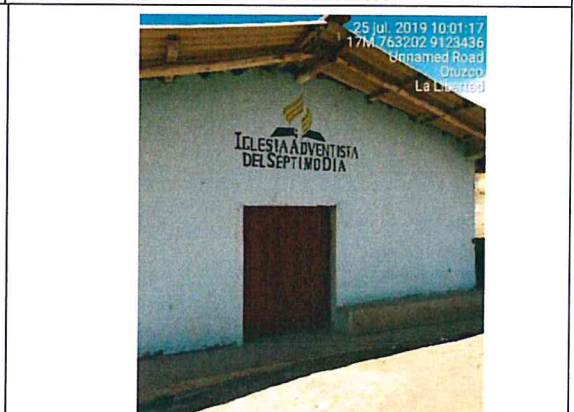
Iglesia adventista de material de adobe con techo de calamina, en buen estado de conservación.
